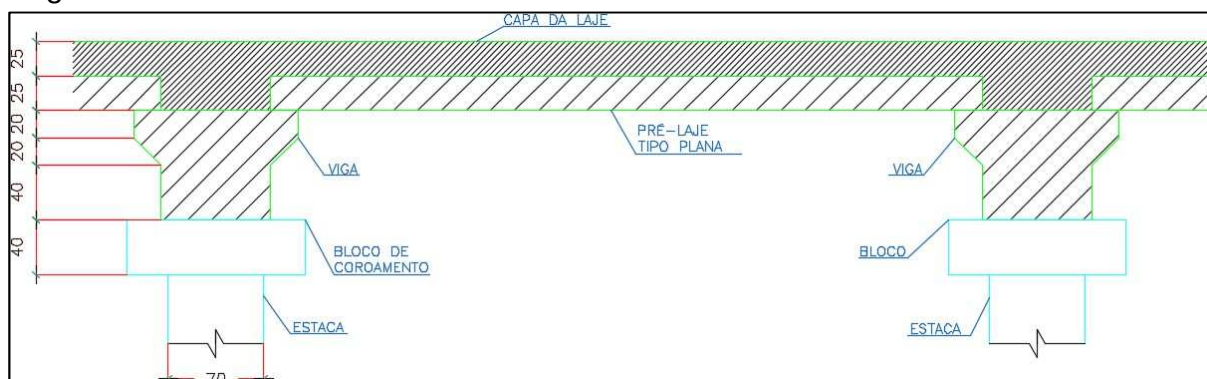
Detalhamento da laje e viga composta do Sistema A
